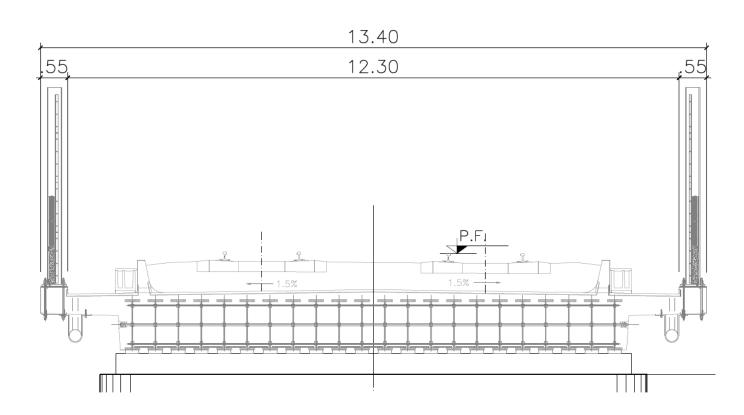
Sezione tipo - trasversale impalcato da 22,0m con travi incorporate.
